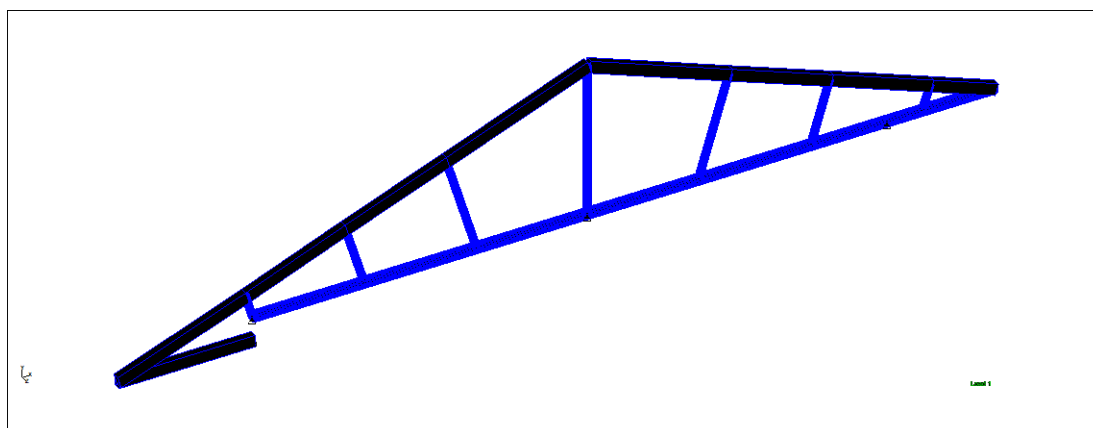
Sección Transversal Cubierta Existente-Piezas. Fuente: Elaboración Propia AutoCAD.
